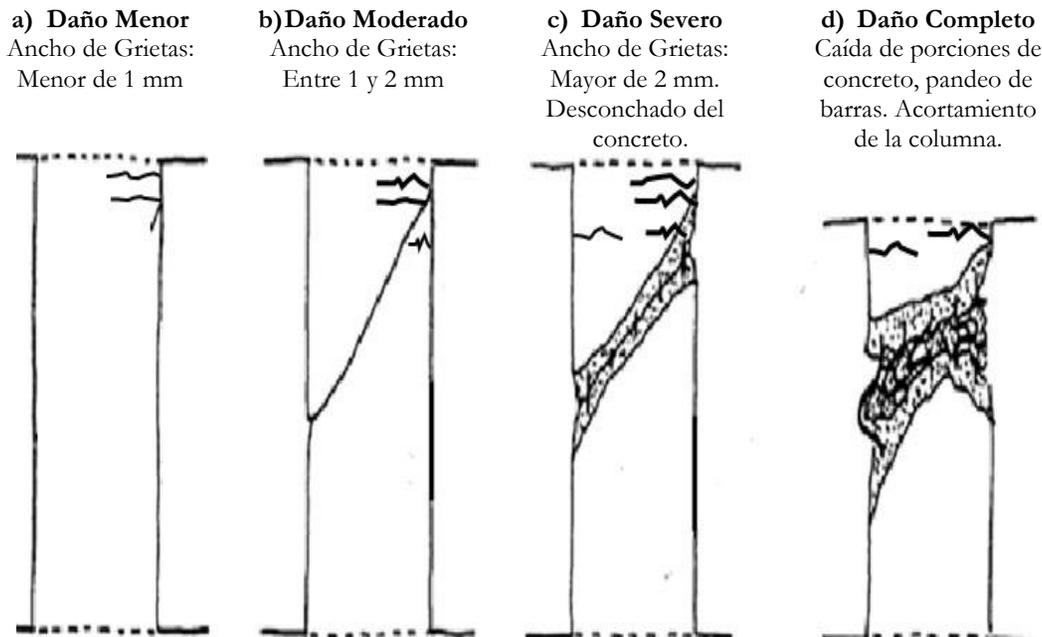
Daños en columnas de concreto armado. Adaptado de Kaminosono et al., 2002.
